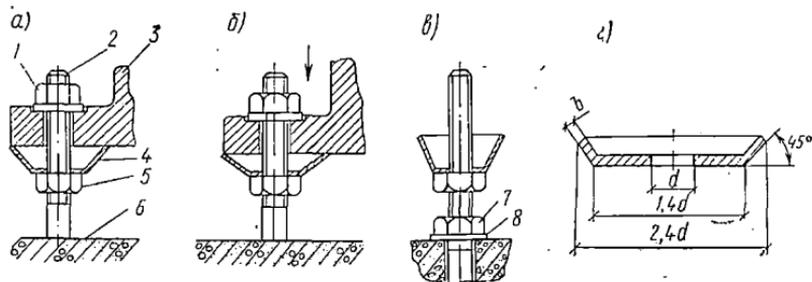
Выверка оборудования на установочных гайках с использованием тарельчатых шайб
